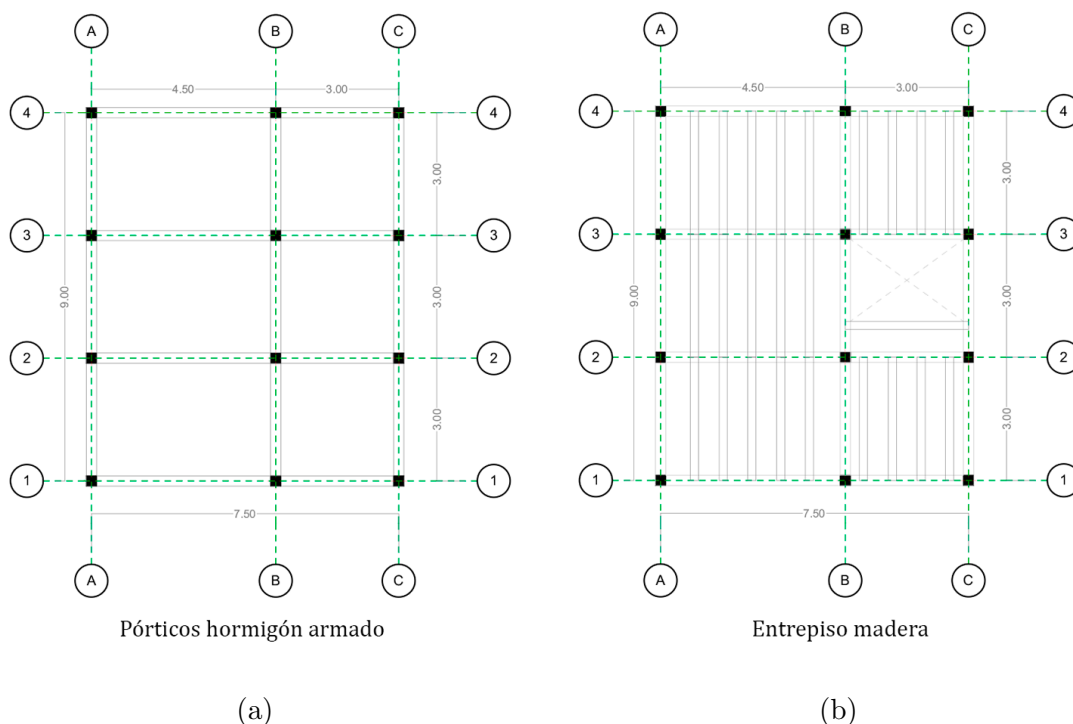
Estructura propuesta a través de la modulación inicial. (a) Pórticos de hormigón armado, (b) Entrepiso de madera.
